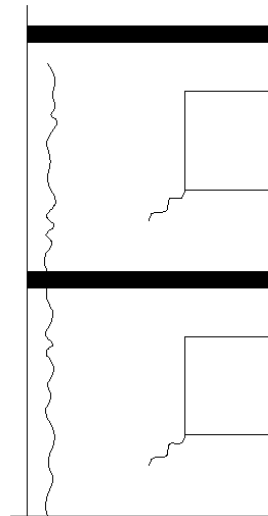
Fissuração vertical devido à expansão dos tijolos por absorção de umidade.
